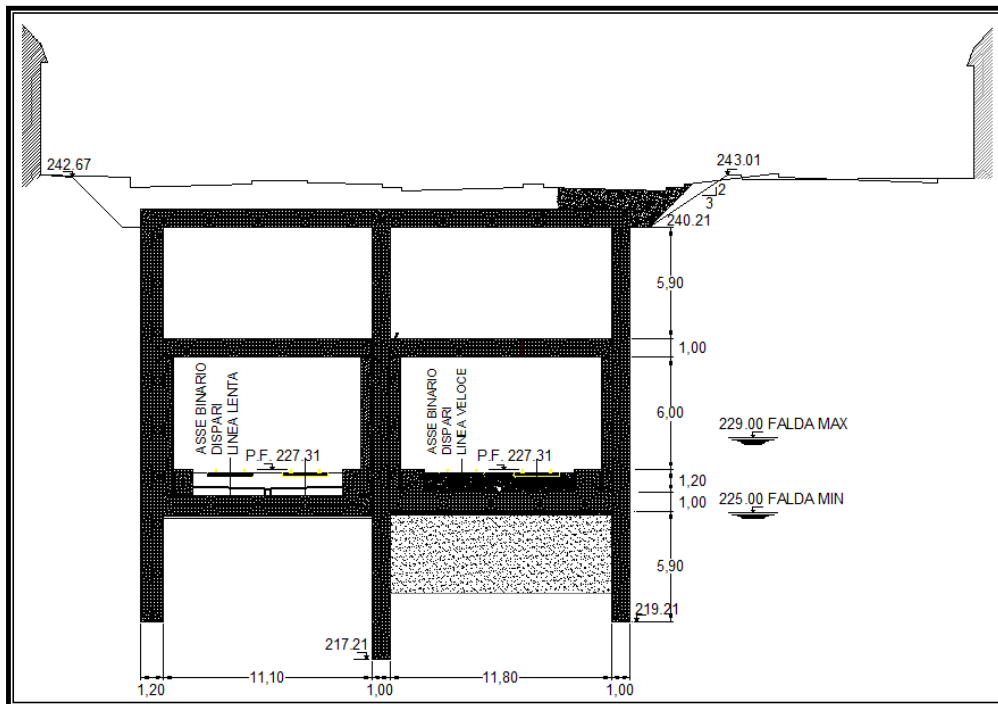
Step 5 e 6. Scavo fino a 224.91 rispetto al p.c. e getto di solettone di fondo.
